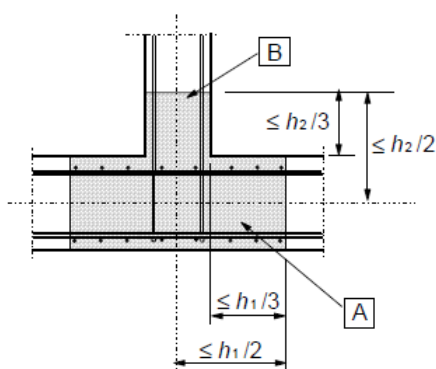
Armaduras transversais nas zonas críticas das vigas (NP EN 1998-1:2010)
